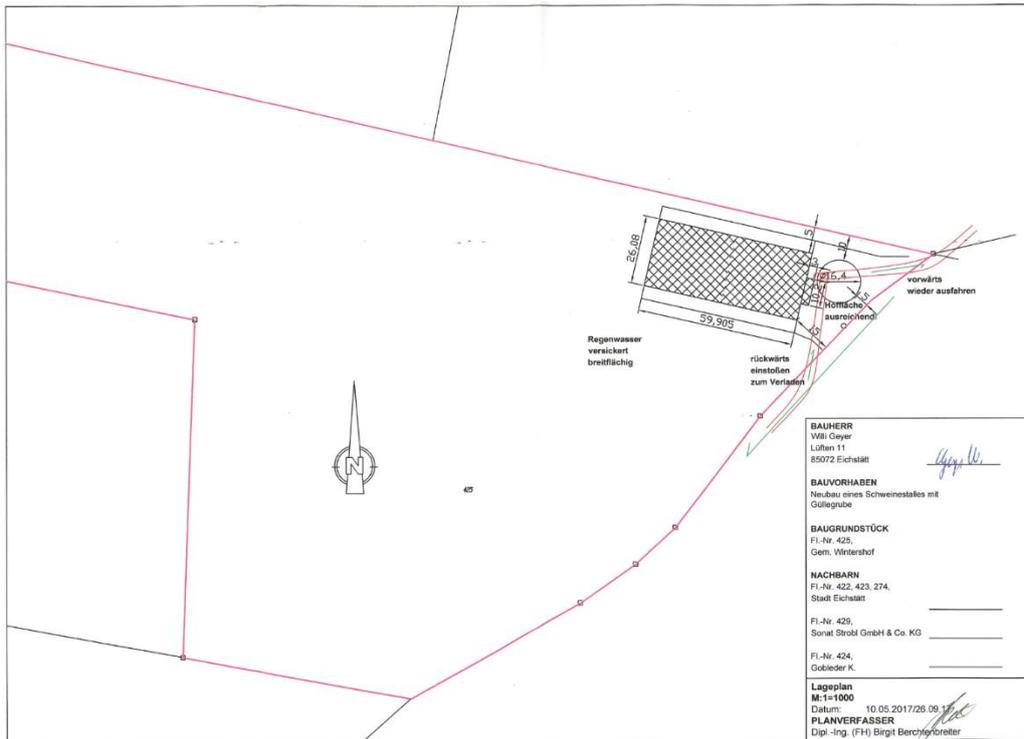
Lageplan mit Erweiterung Bauungsplan, geplantes Mastschweinestall und bestehender Pferdehaltung
